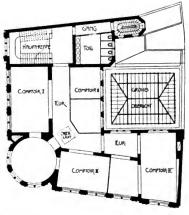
Grundrisse der Nationalbank. I. Obergeschofs.
